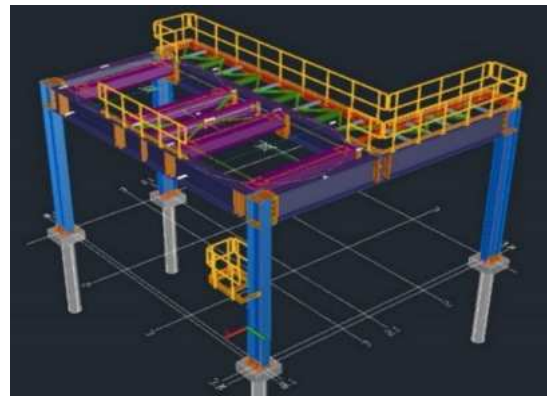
Projeto e preparação da uma estrutura metálica para ETAR de Gaia, Porto.
